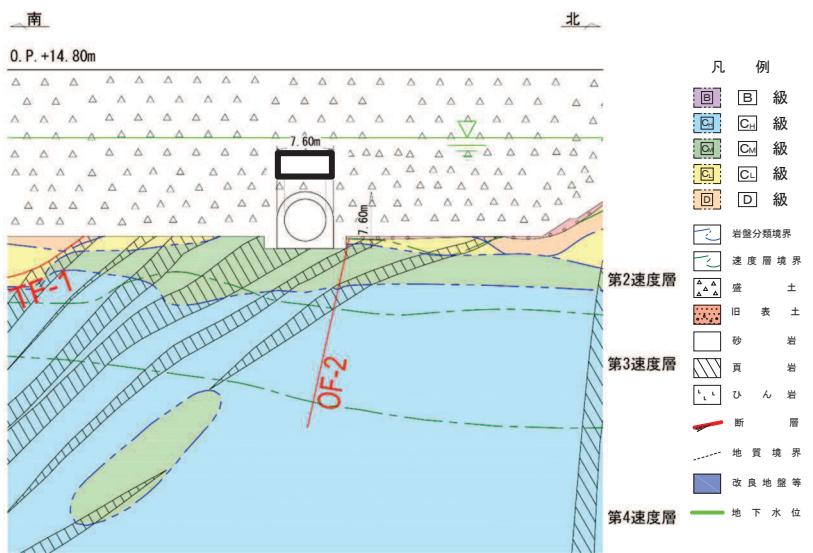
排気筒連絡ダクト（土砂部）評価対象断面図（断面①）
